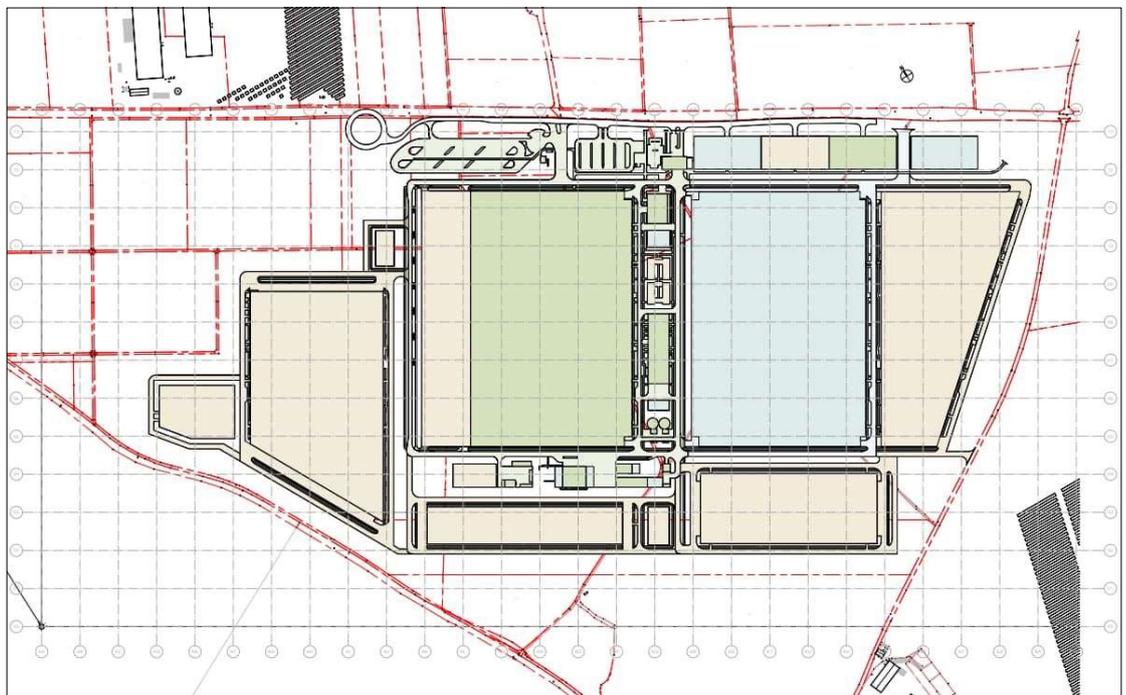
Planfall 3 mit Gebäuden (BA1 hellgrün, BA2 hellblau, BA3 gelb).
